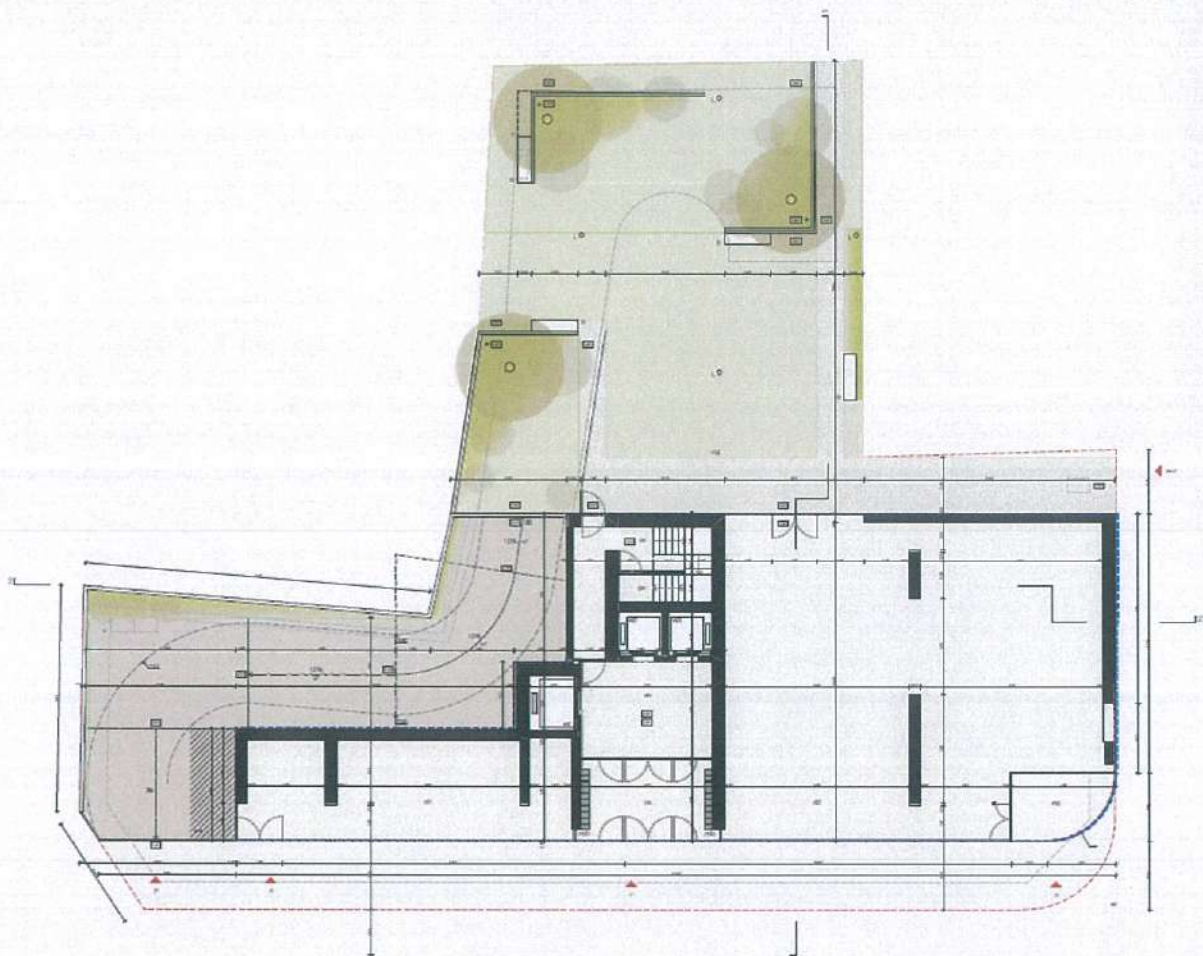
Planimetria e katit perdhe – Ambiente Sherbime
